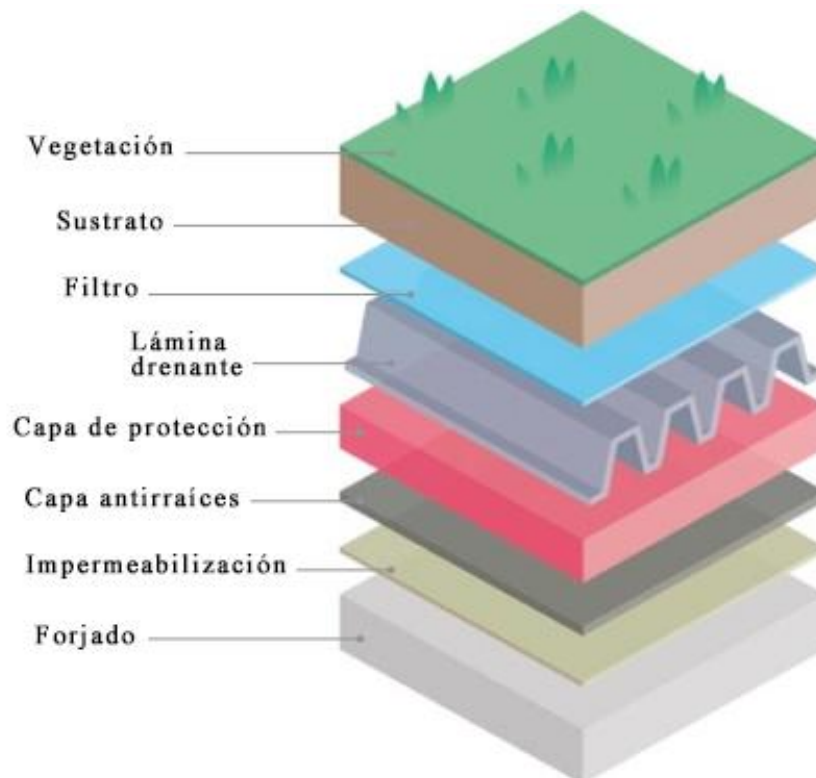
Capas de una cubierta verde. [Fuente: Guía de Cubiertas verdes del Ayuntamiento de Barcelona, 2017]
